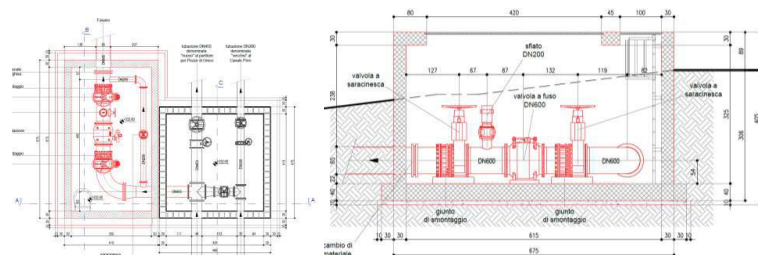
IN ROSSO Pianta e sezione della nuova camera di collegamento a monte
